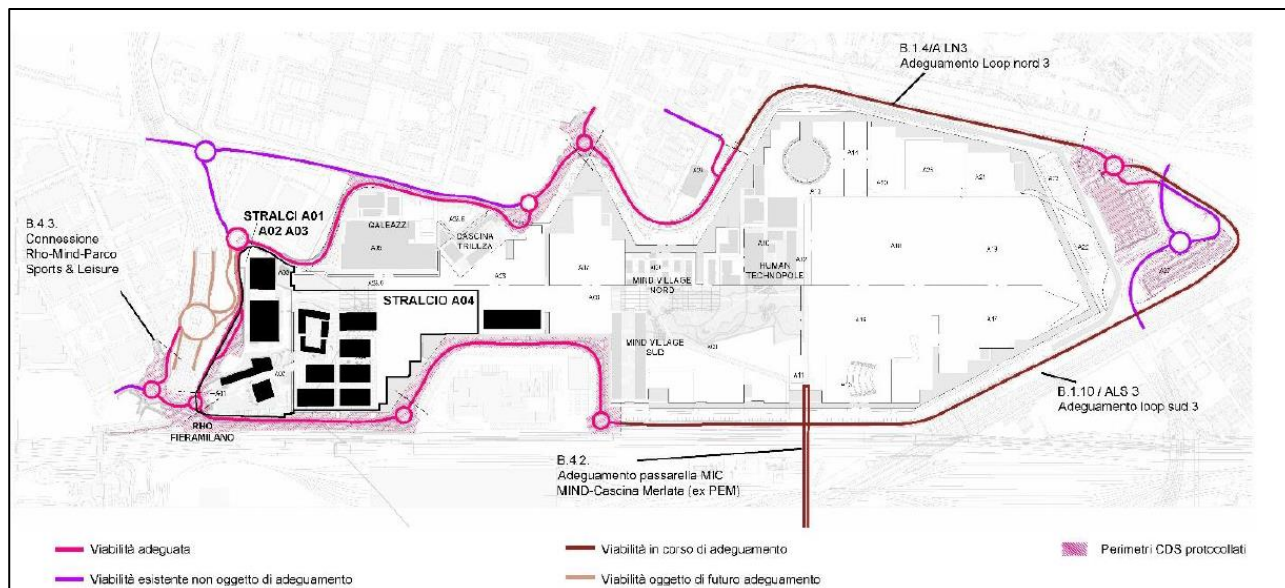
Planimetria di MIND all'orizzonte T4 (fonte STUDIO MIND)
